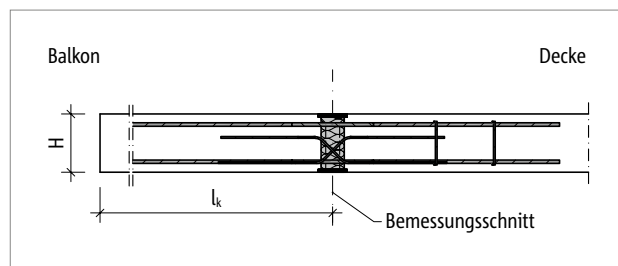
Schöck Isokorb® T Typ DP: Statisches System
